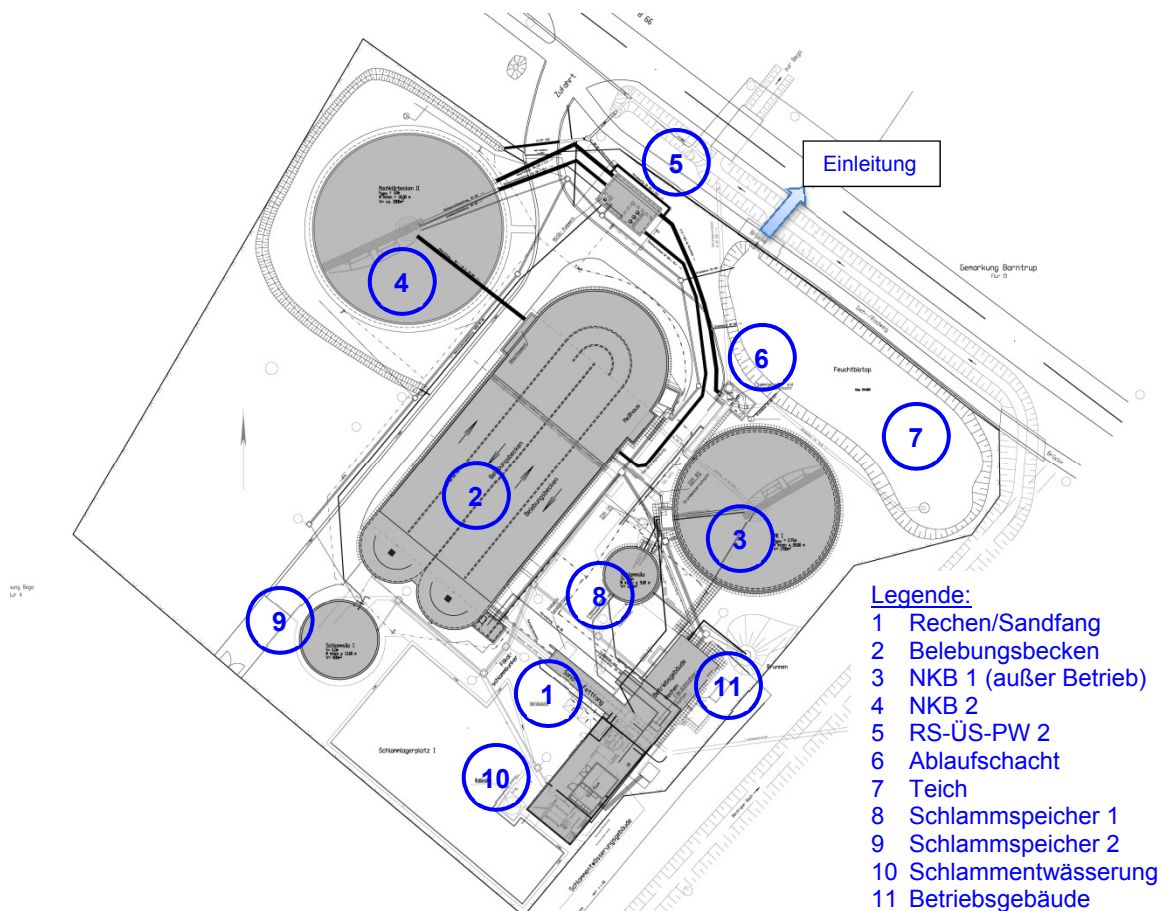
Lageplan Kläranlage der Stadt Barntrop (Danjes 2013)
